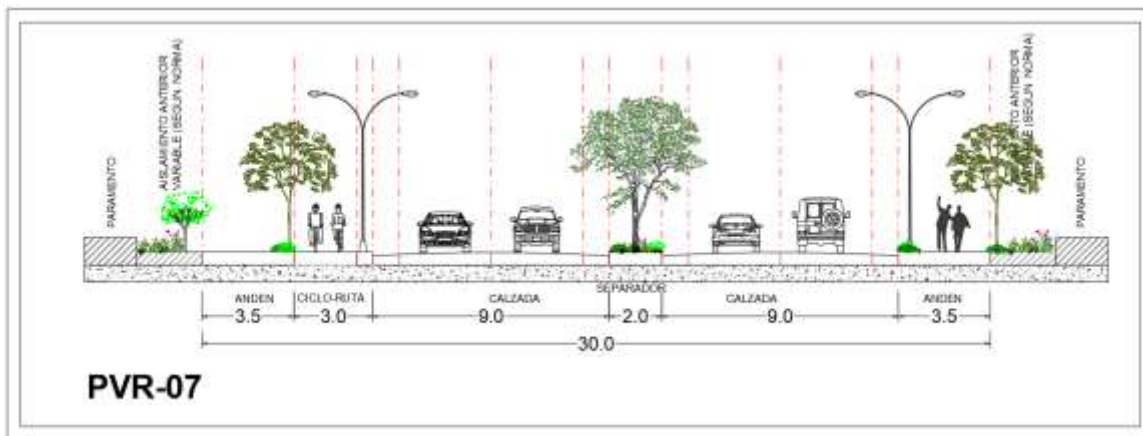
Perfil PVR-07 de la proyección de la Avenida Las Palmas y la vía interna del área suburbana.
